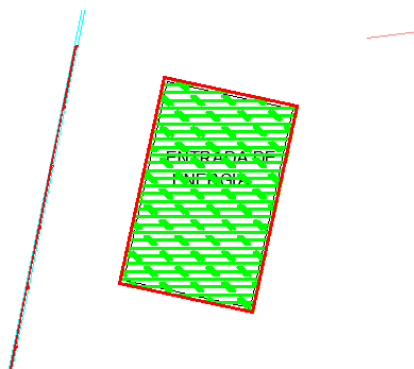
Área considerada para pavimento final (Entrada de energia)
